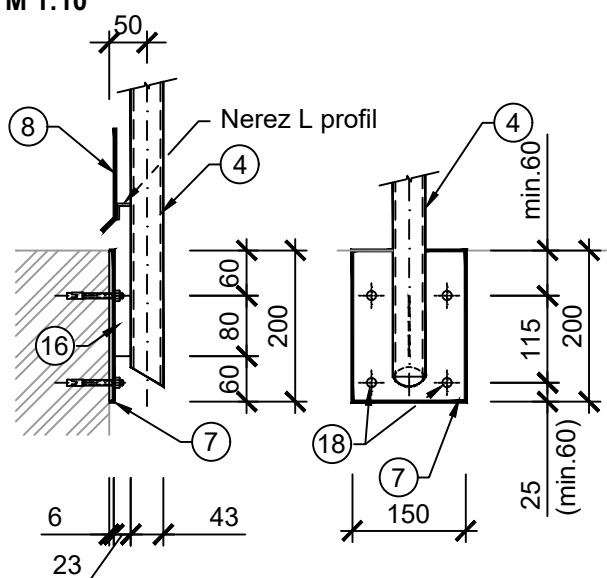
DETAIL "B" - dvojitá kotevní deska Kotvení shora
